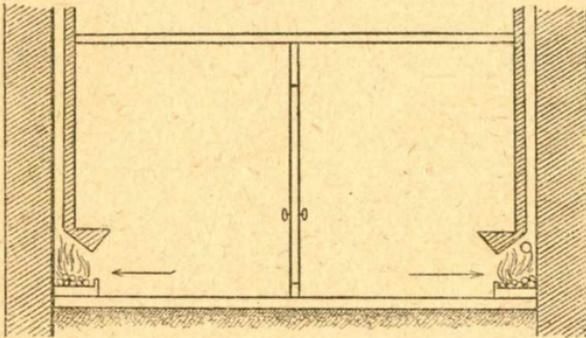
Conduit de fumée débouchant dans le conduit d'une cheminée voisine.
